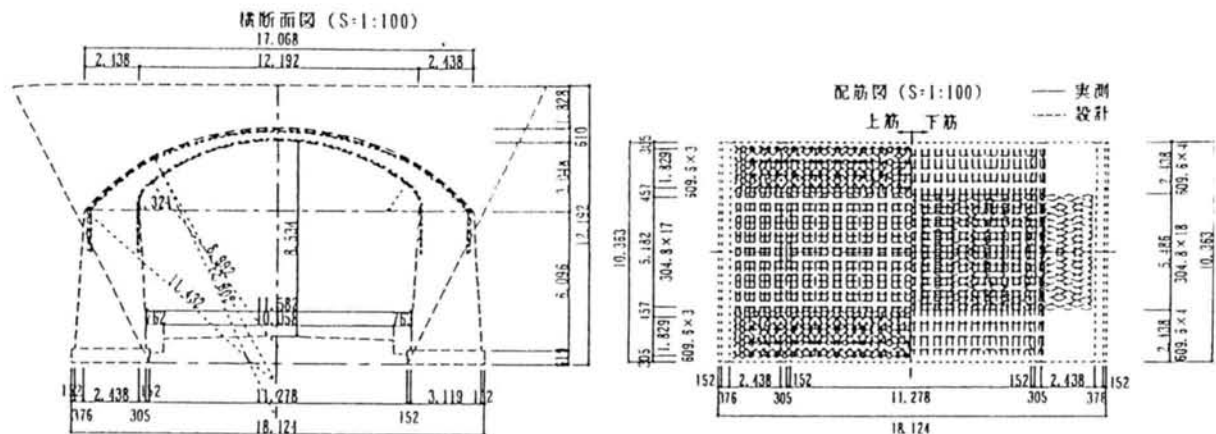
石川橋、横断面図（県庁側）及び鉄筋配置図<sup>58)</sup>
